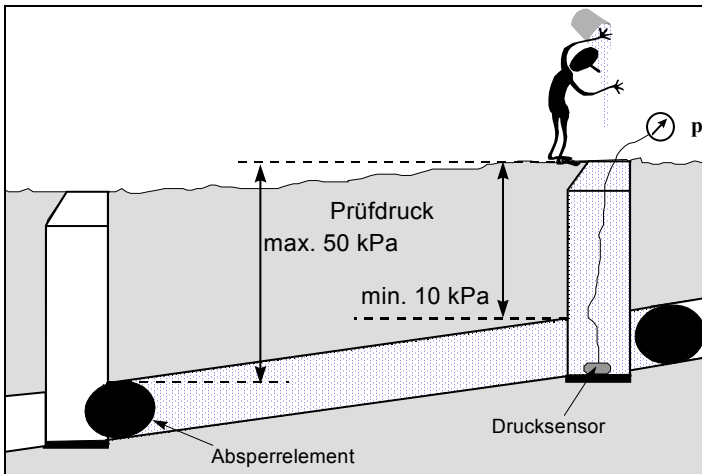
Haltungsweise Wasserdruckprüfung (inkl. Schacht) nach DIN EN 1610 (schematische Darstellung)
